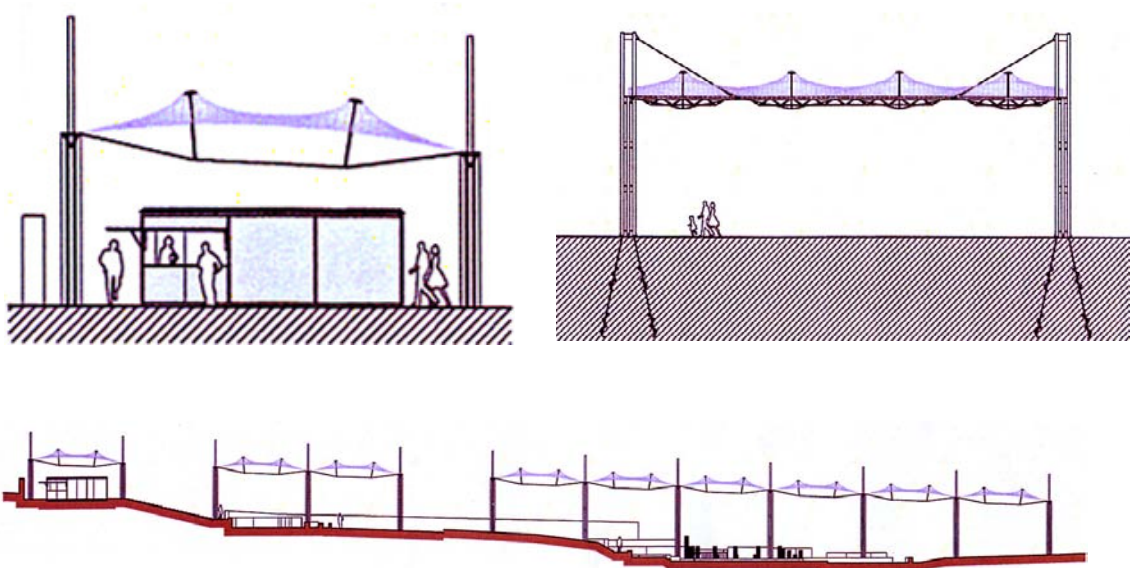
Secciones y alzado de los módulos de estructura y cubierta
